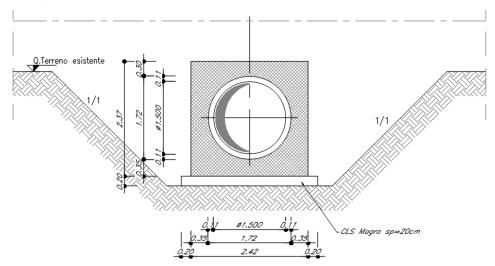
Sezione trasversale dell'opera tubo Ø1500
